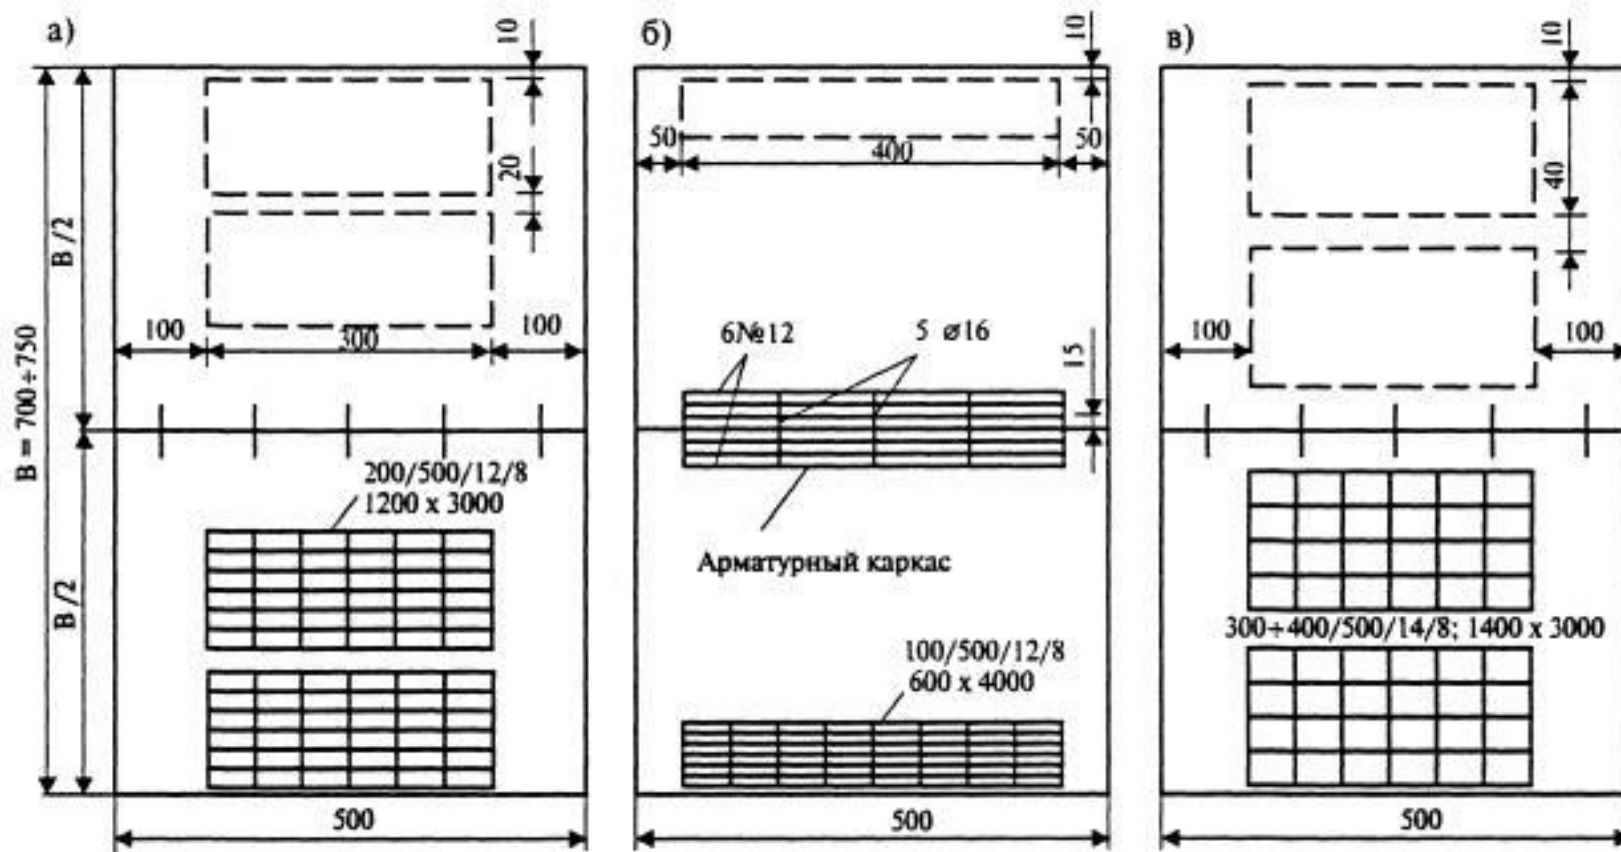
Схемы армирования плит цементобетонных покрытий автомобильных дорог
